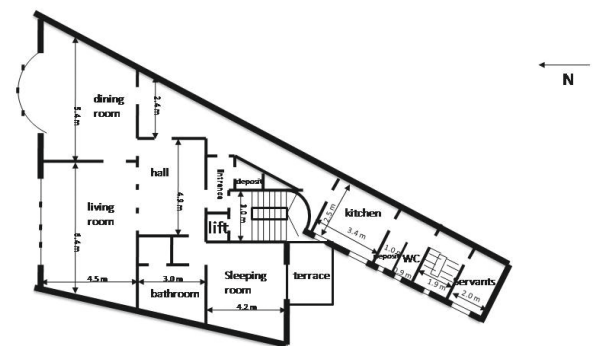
Archibild vom Dr. Roth Gebäude – Plan.
